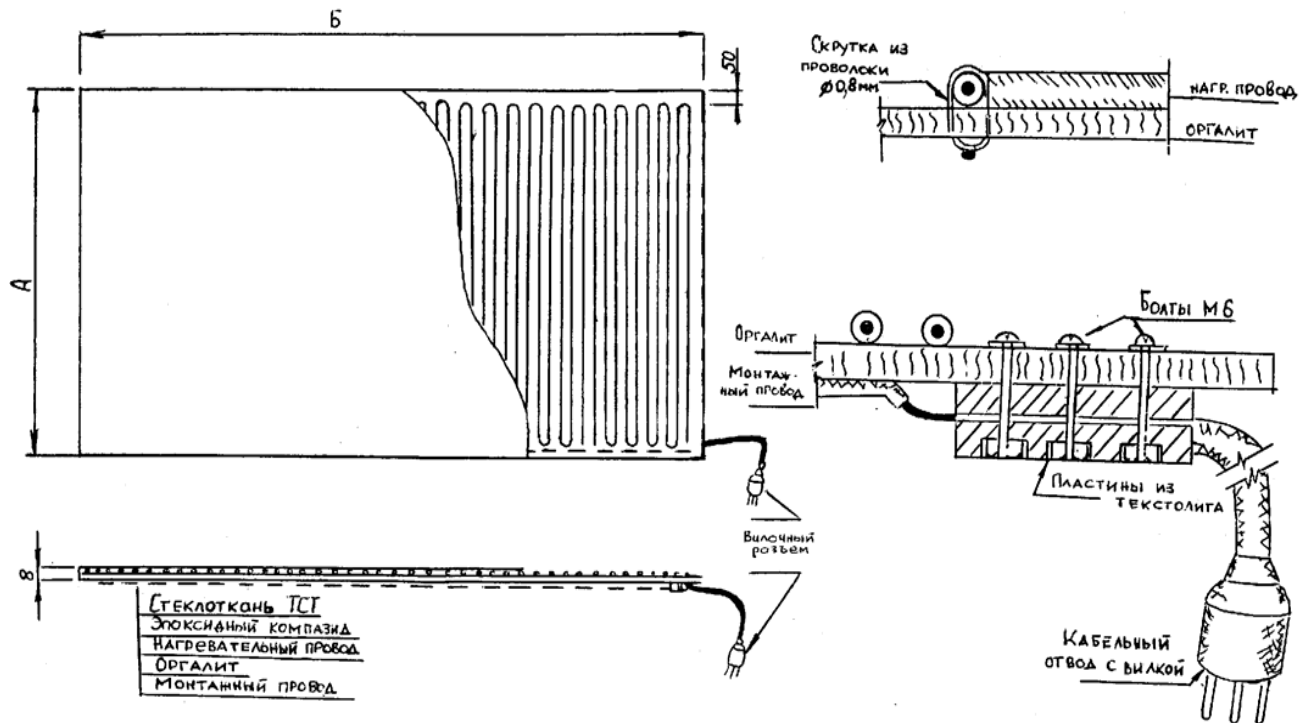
Инвентарный греющий плоский элемент покрытия бетона
